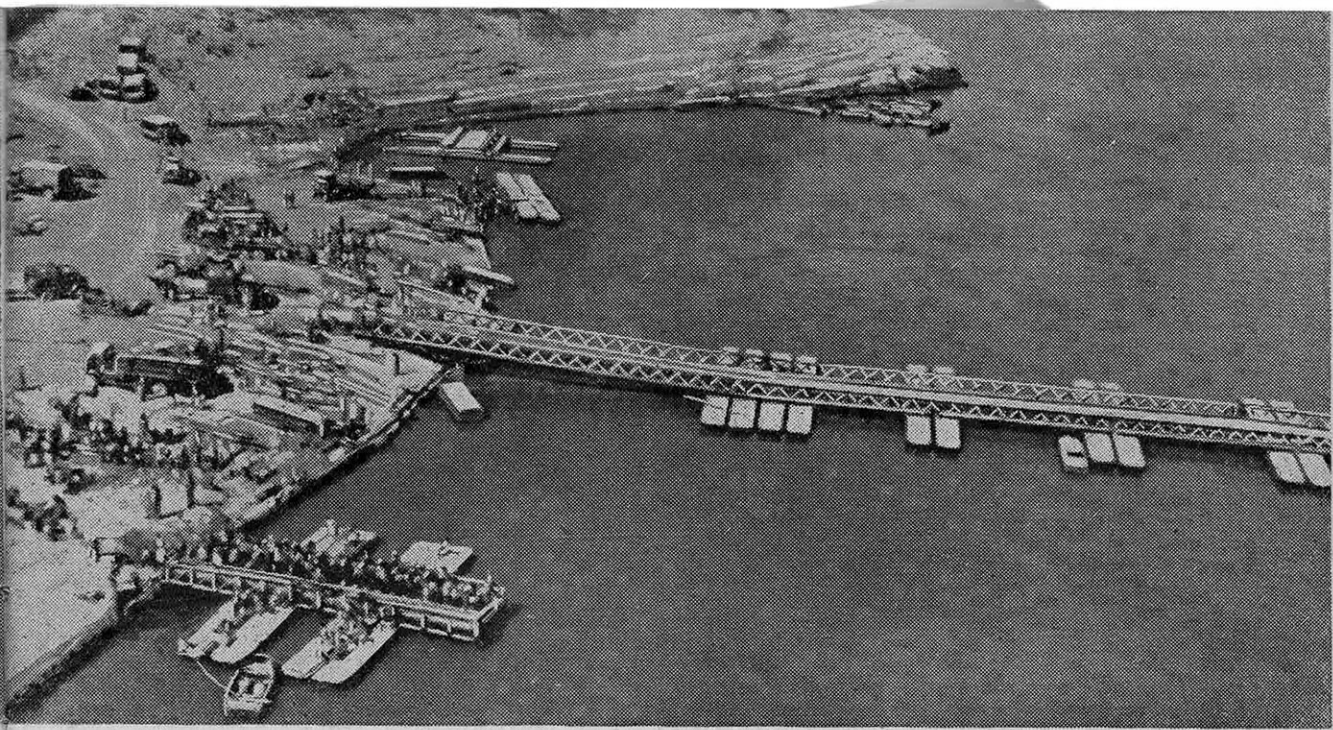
DOUZE HEURES APRÈS LA PRISE DE KALEWA, UN PONT BAILEY (1) EST EN CONSTRUCTION SUR LA RIVIÈRE CHIDWIN (O.W.I.)
